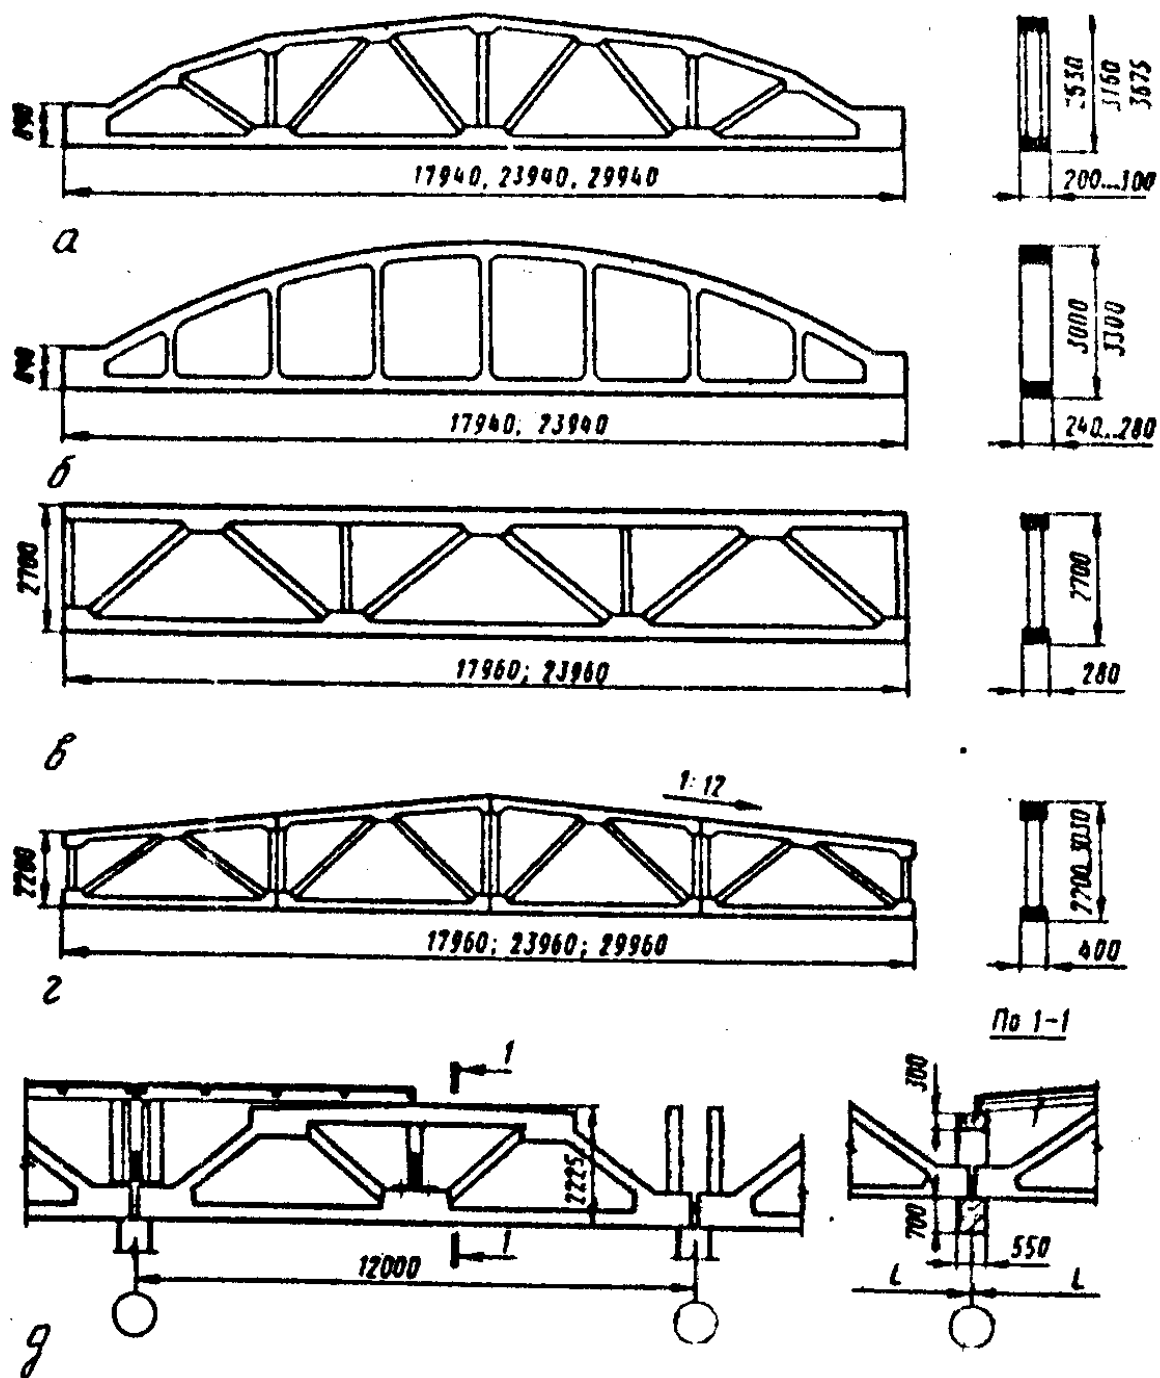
Схеми залізобетонних ферм: а - сегментних; б - арочних безрозкосних; в - із паралельними поясами; г - полігональних; д - підкрівляних
